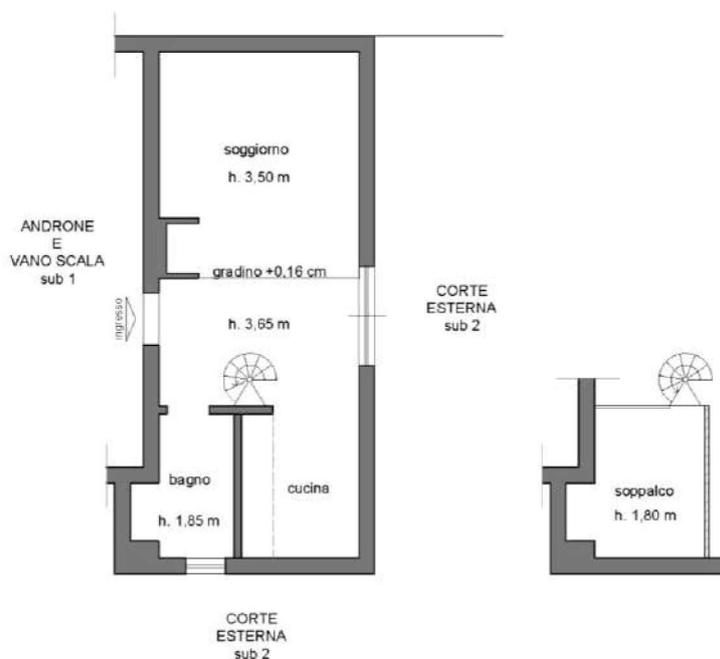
planimetria dell’unità immobiliare sub 13 Piano terra
